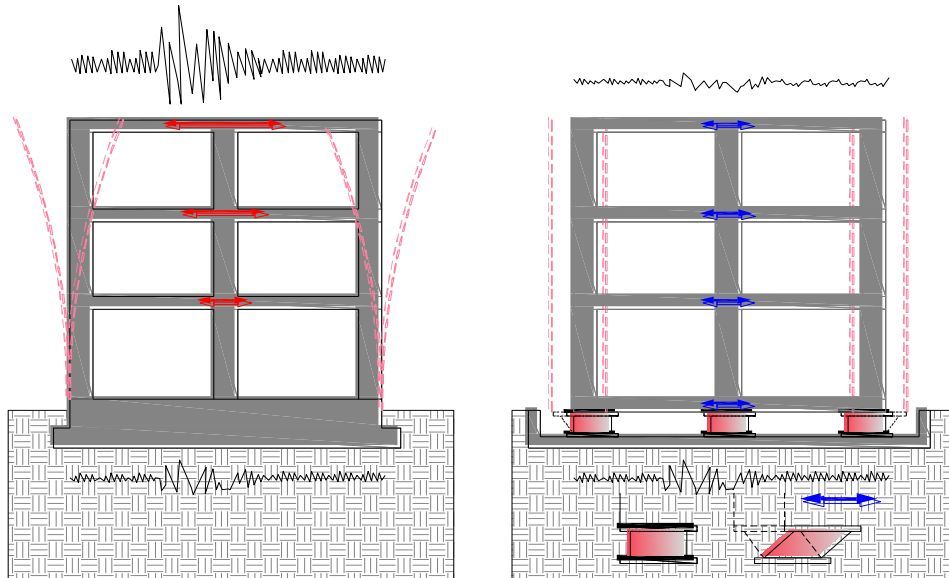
b. Esquema de estructura sin aislación basal y con aislación.
